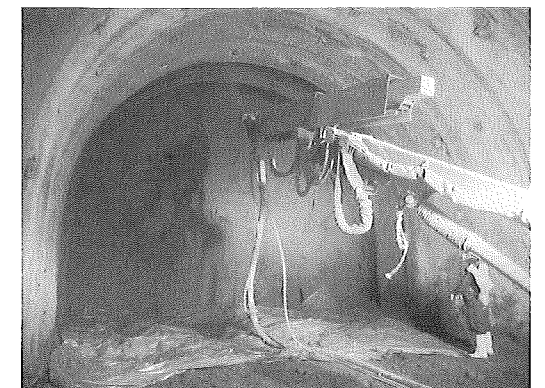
作業坑試験施工状況(ハイブリッド急結剤)
